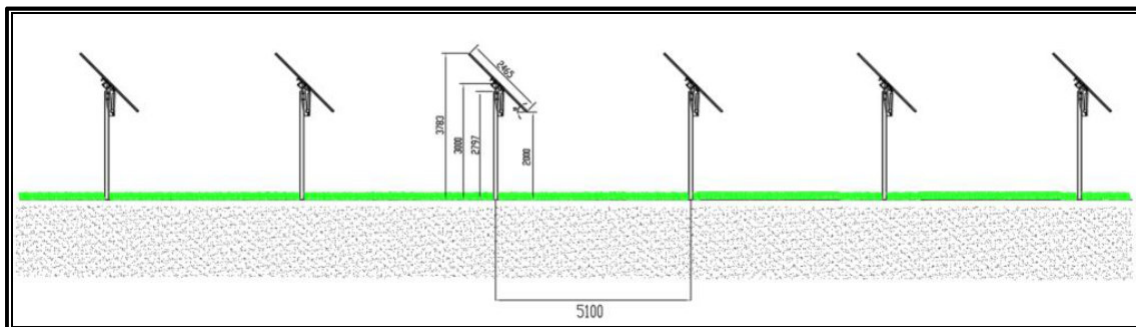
Particolare strutture ad inseguimento Tracker tipo 1P
